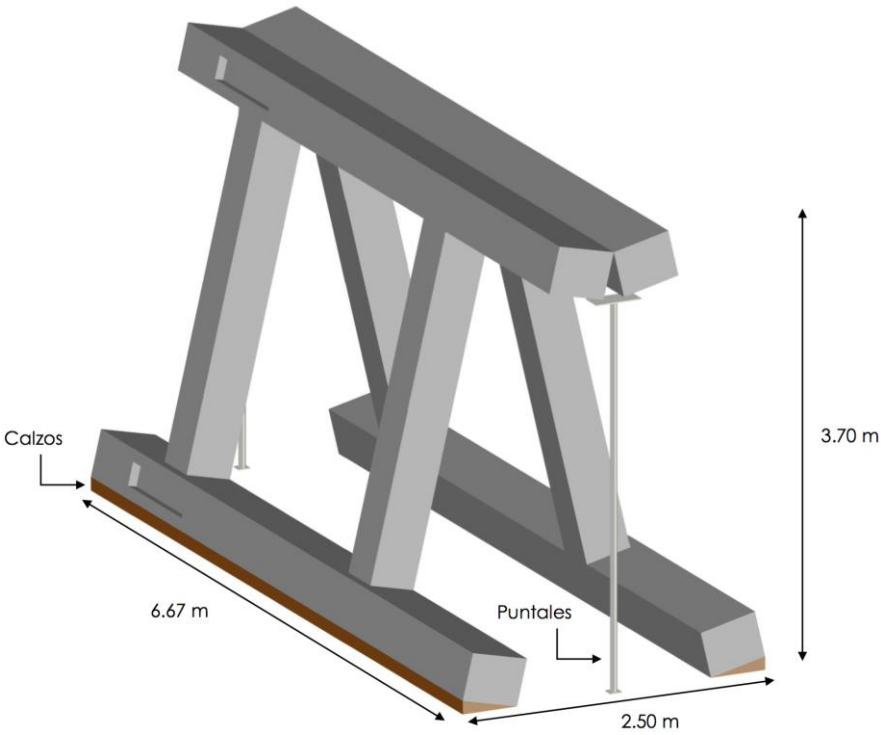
Disposición abatida de los módulos de tablero para transporte en góndola de cama rebajada
